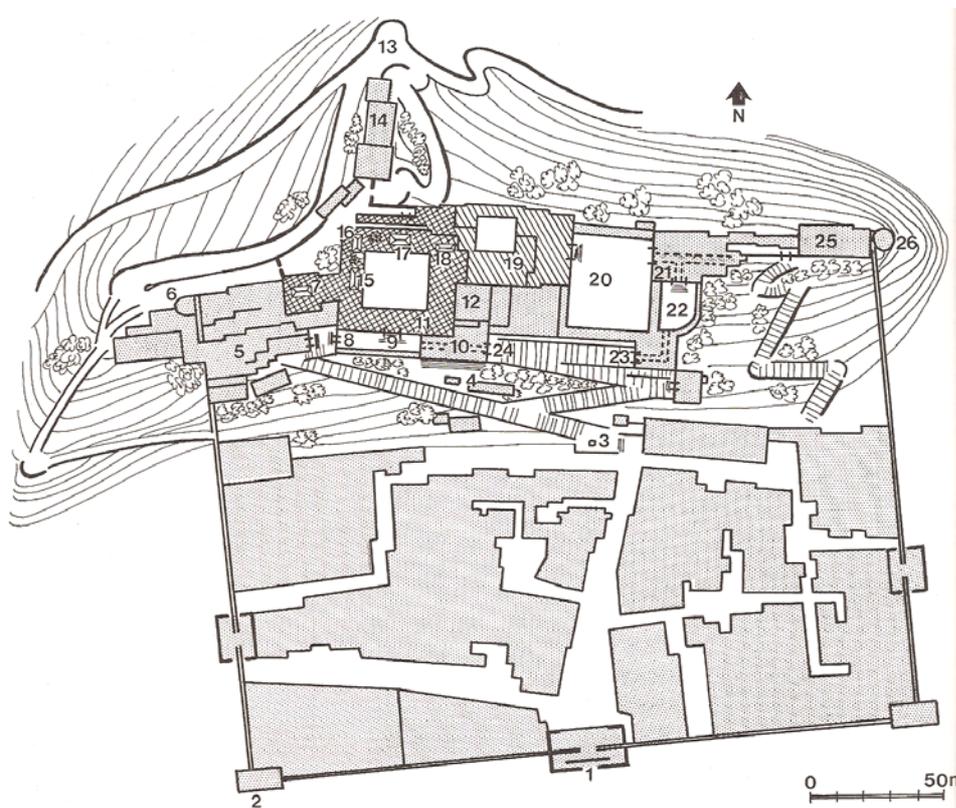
Schematischer Grundriss des Potala Palasts, 1: zentraler Befestigungsturm, 2: Eckturm, 3: unterer Treppenabsatz mittlere Zugangsrampe, 4: Gebäude der Thankas, 5: Mönchsresiden-
